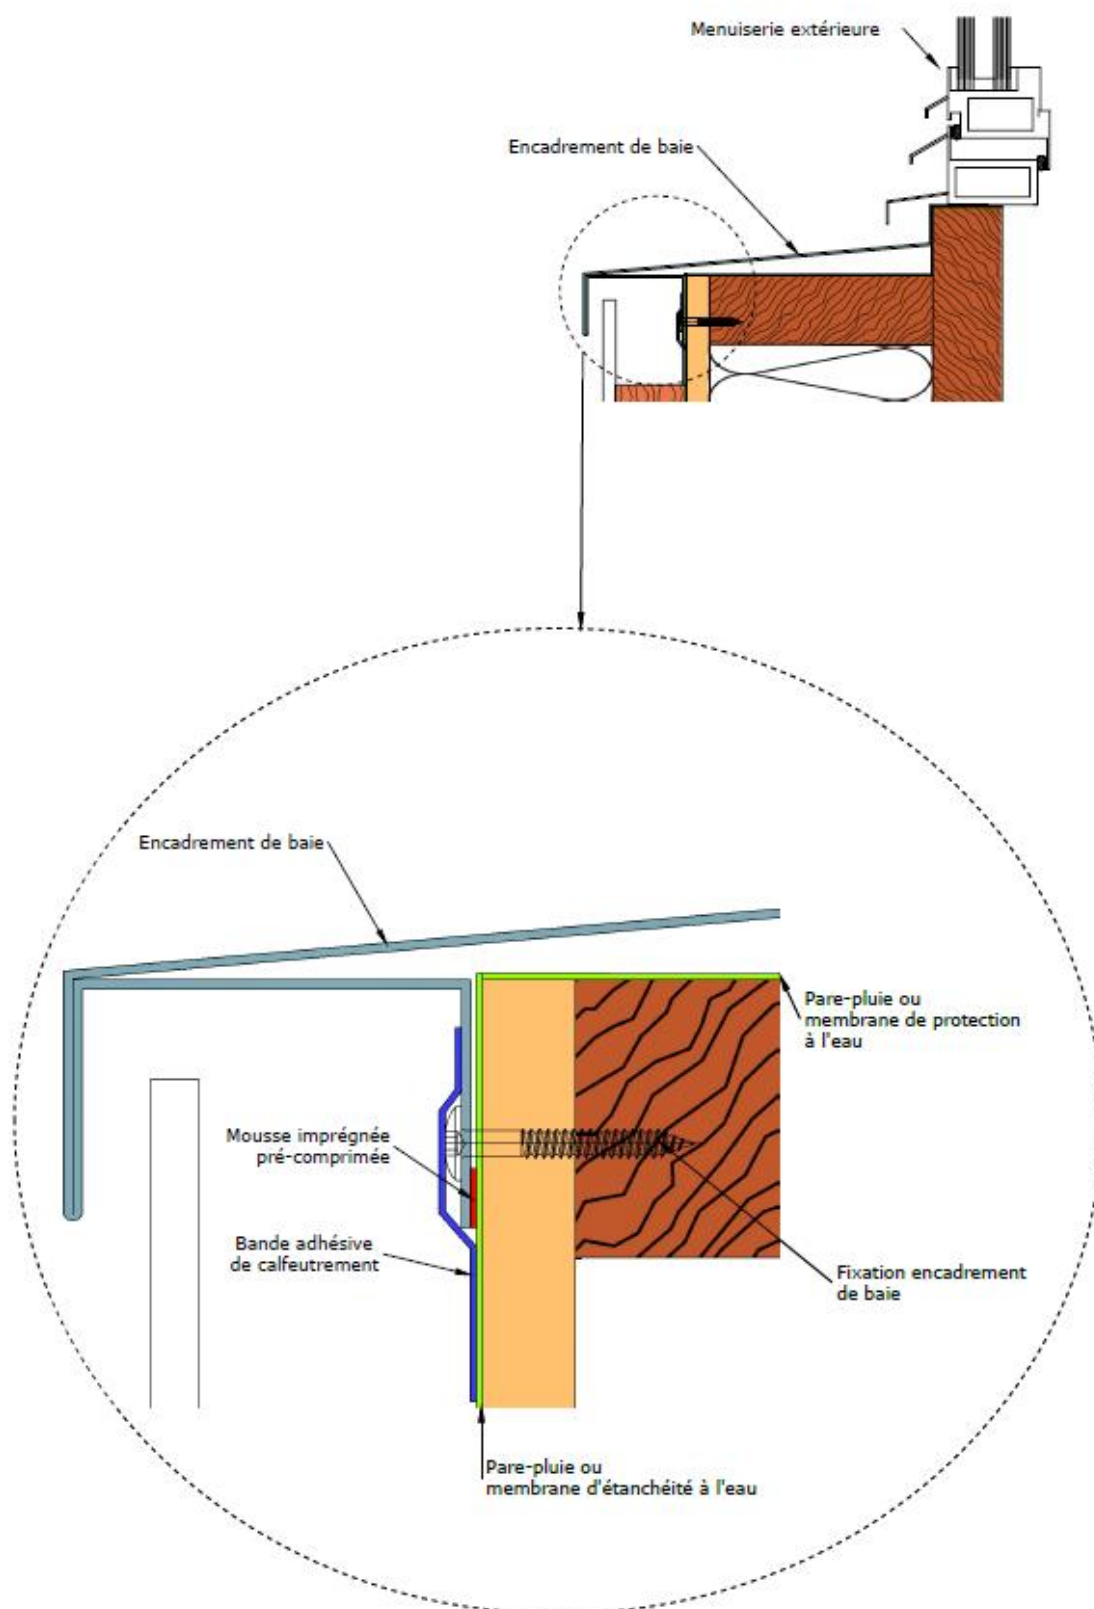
Liaison pare-pluie ou membrane de protection à l'eau avec encadrement de baie monobloc soudé 4 cotés acier 15/10e, Ee2, coupe verticale appuis
